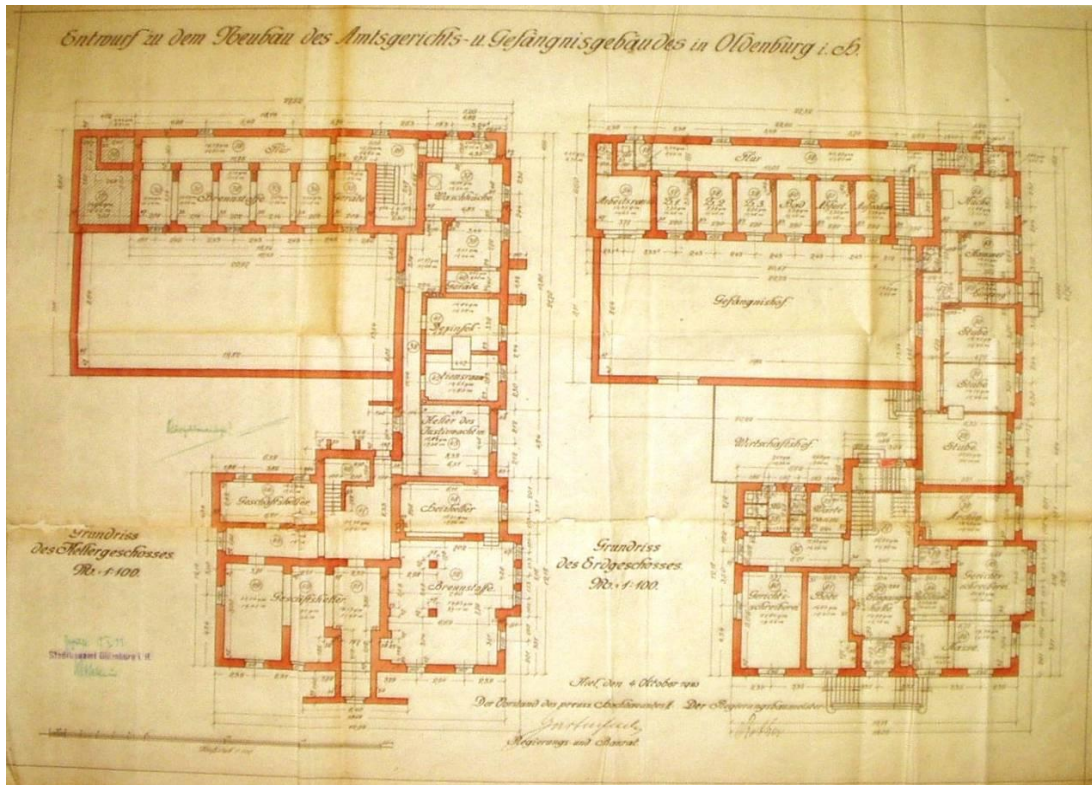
Amtsgericht in Oldenburg. Grundriss des Kellergeschosses und des Erdgeschosses.
